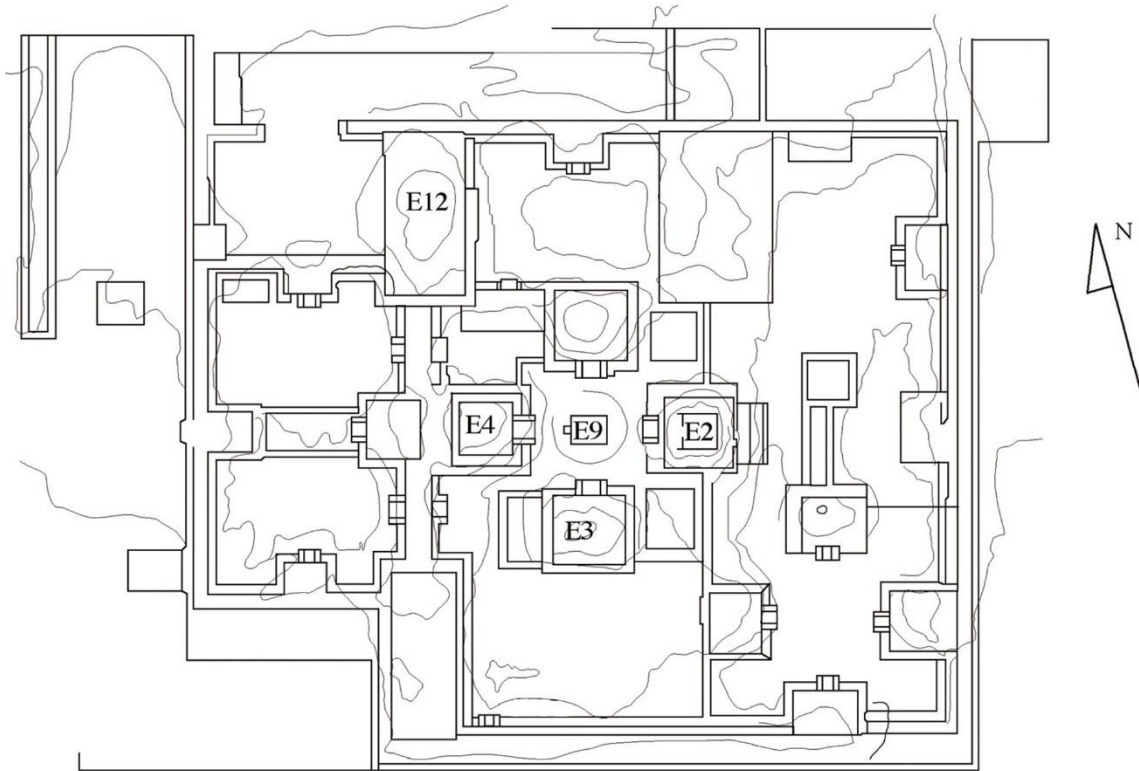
Planta del complejo de Xalla, en el que se señala las estructuras donde se ubicarían las posibles subestructuras tempranas (modificado de Manzanilla 2009a:290).
